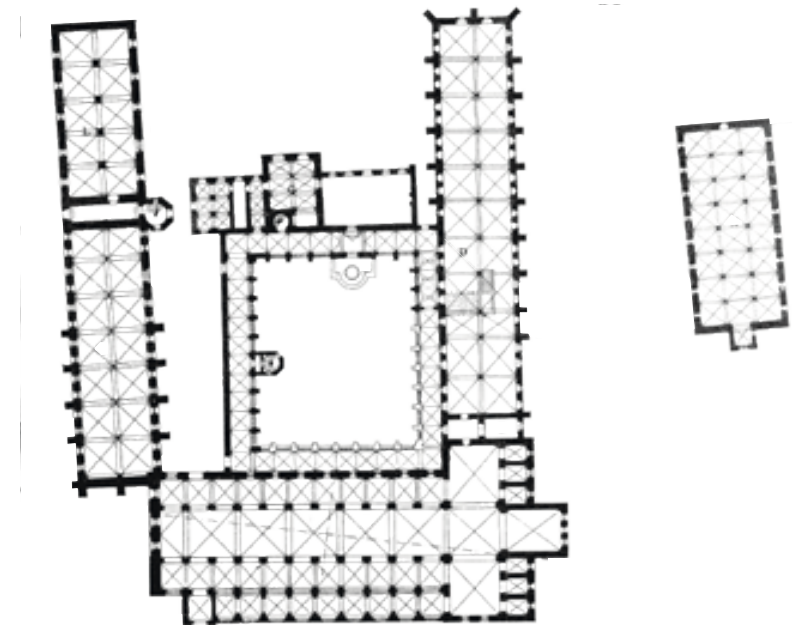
Grundriss Klosteranlage Eberbach
